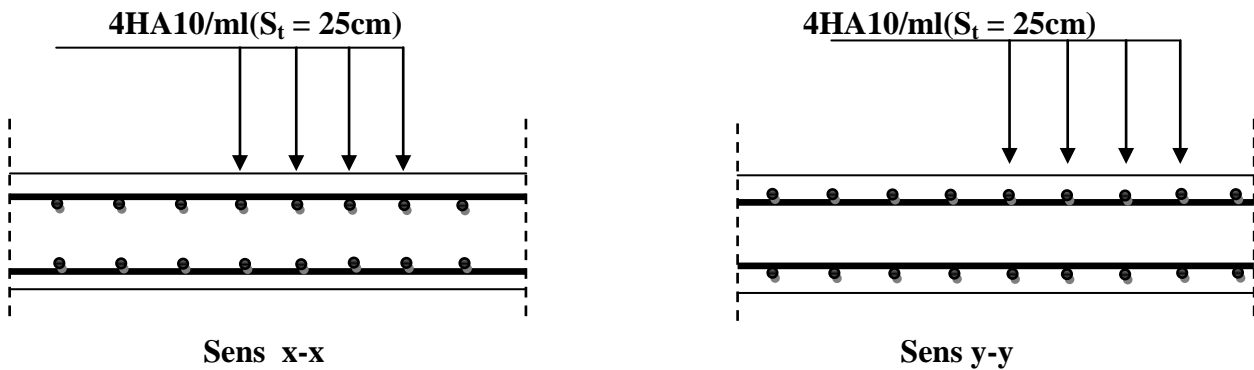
Plan de ferrailage de la dalle pleine de la salle machine
